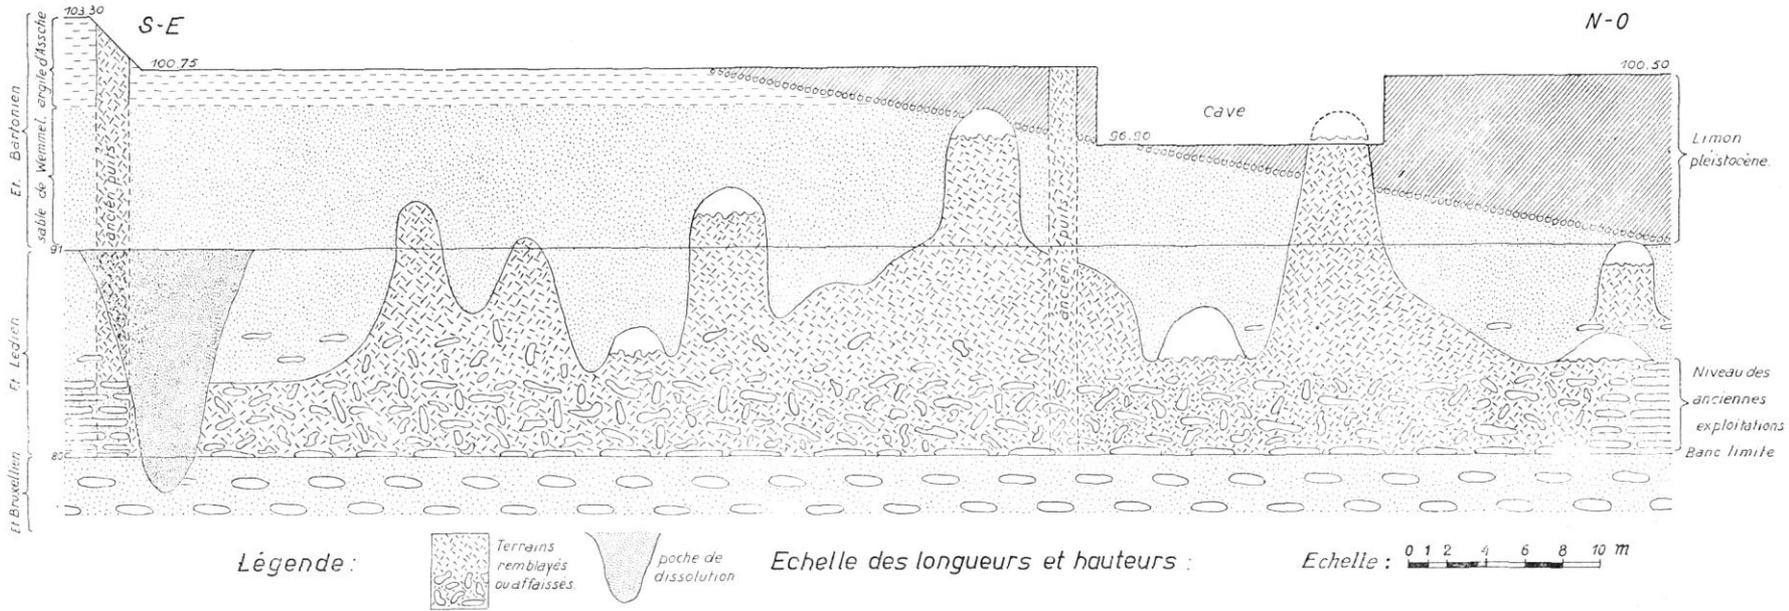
Institut des Constructions Civiles. Coupe schématique du terrain.
